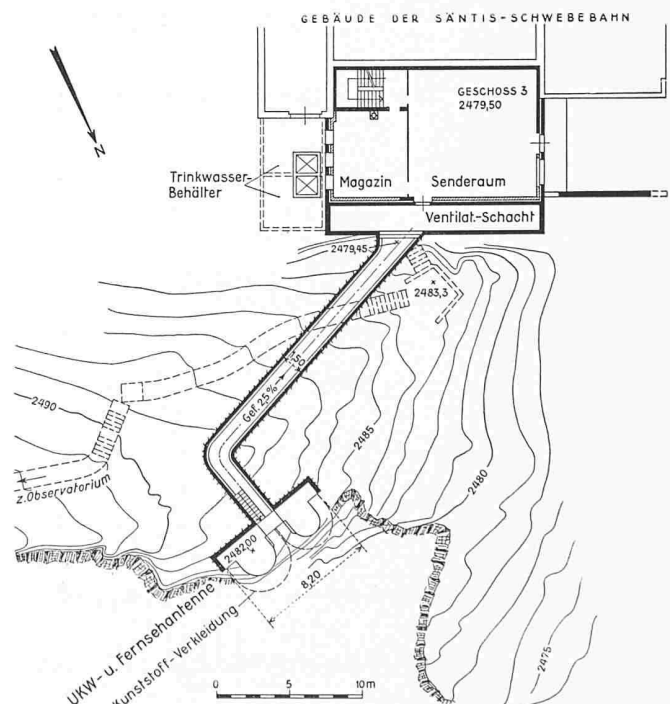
Lageplan der Gesamtanlage, Masstab 1:500
